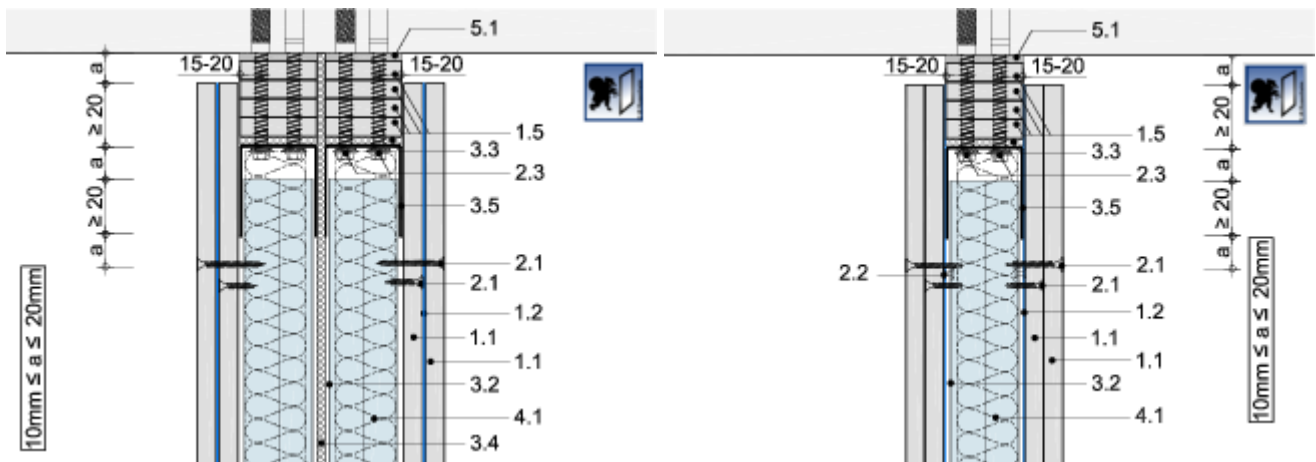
Deckenanschluss Doppelständerwand RC 2 mit erhöhtem Schallschutz
